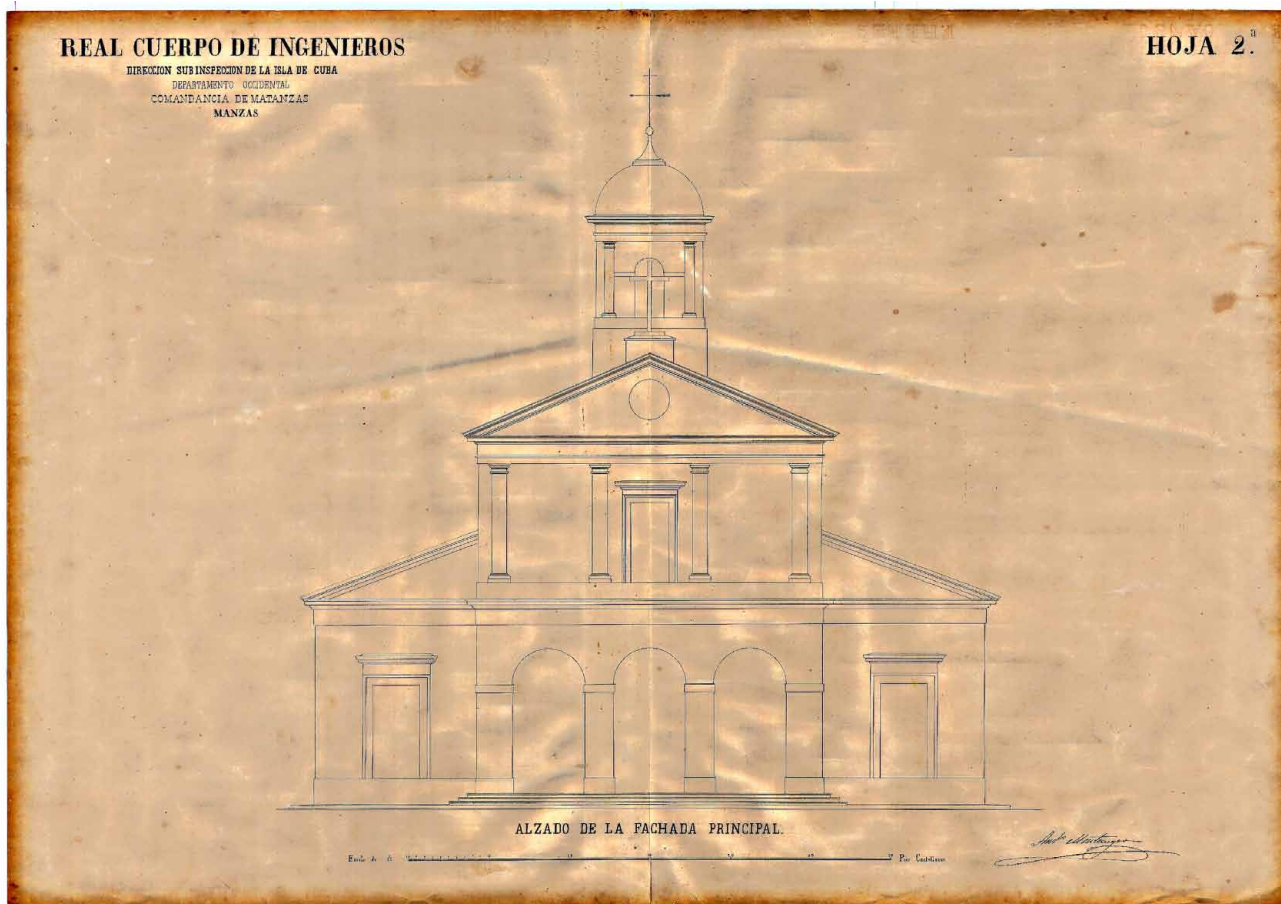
Alzado de la fachada principal. IHCM, CAGMM, CUB-194/11.
